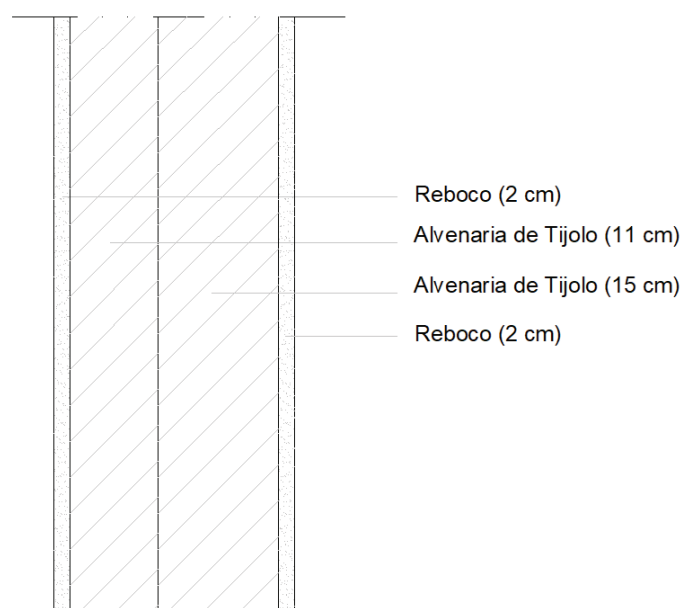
Pormenor construtivo da parede interior tipo VII (circulação)
